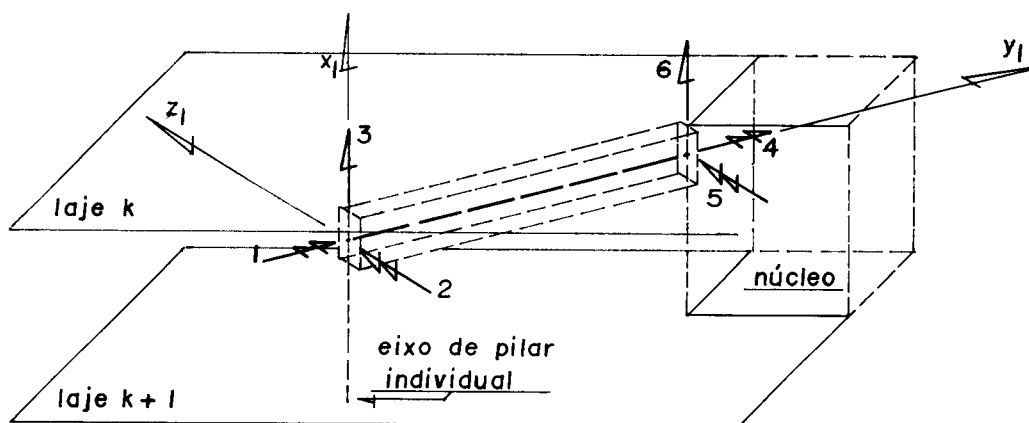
2. - Coordenadas deslocamentos para as vigas pilar-núcleo.
